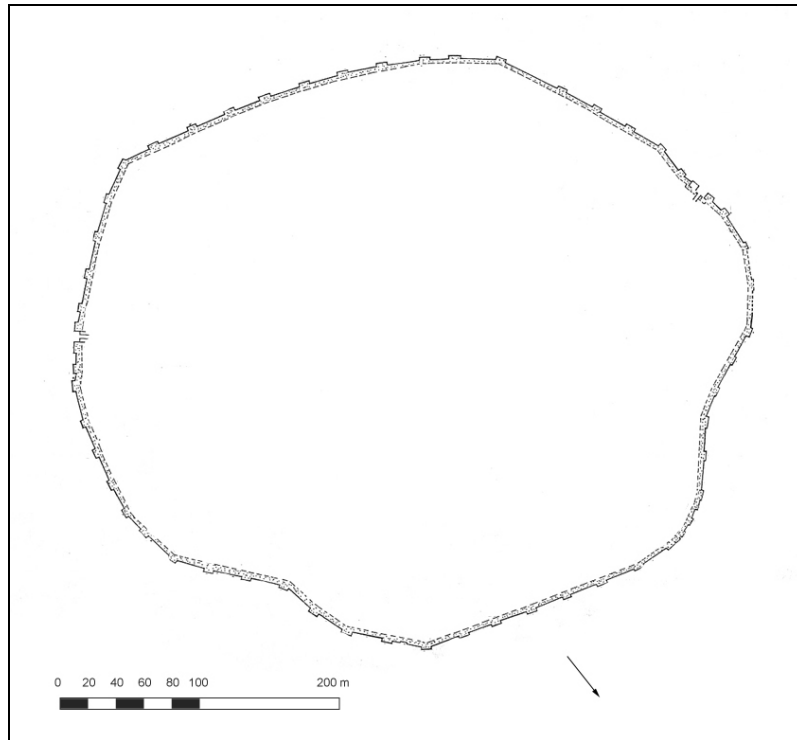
plan d'al-Baydâ' (J.-F. Breton, 1985, fig. 8).
